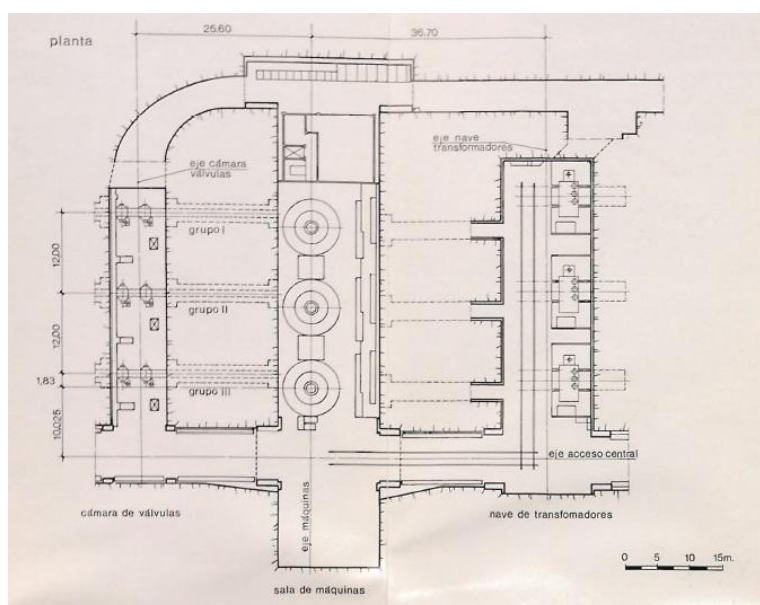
Planta Central Hidroeléctrica Reversible Moralets. Fuente: Fundación Arquia, (s. f.)
